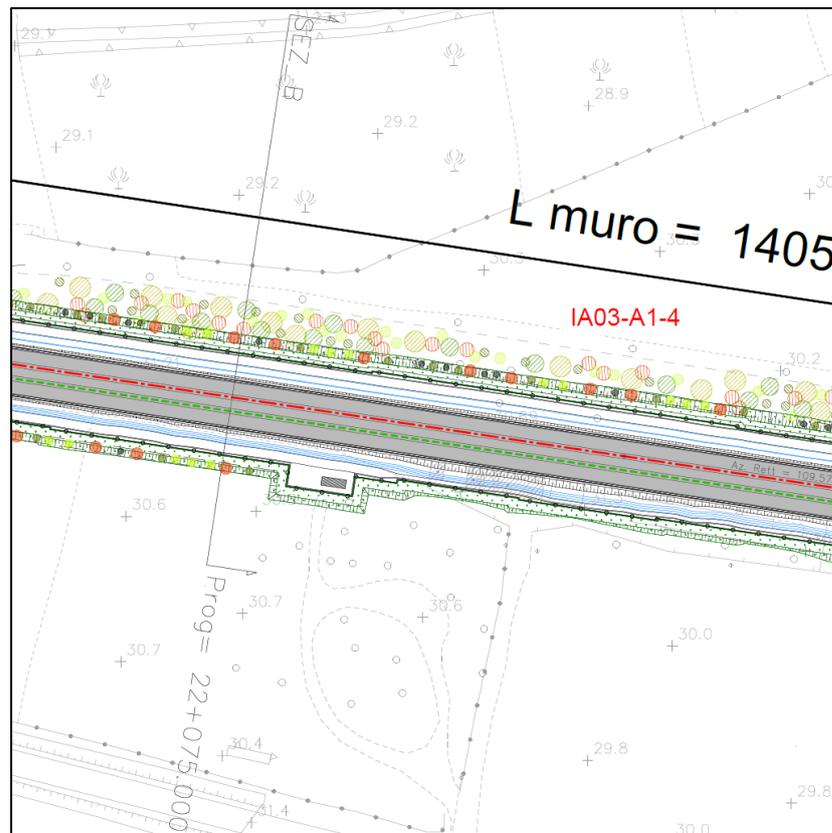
Stralcio planimetrico relativo agli interventi previsti sulle dune, progressiva 22 + 075.000 (estratto planimetria RS39-10-V-ZZ-P7-IA0000-002 - Planimetria degli interventi 2/4)
